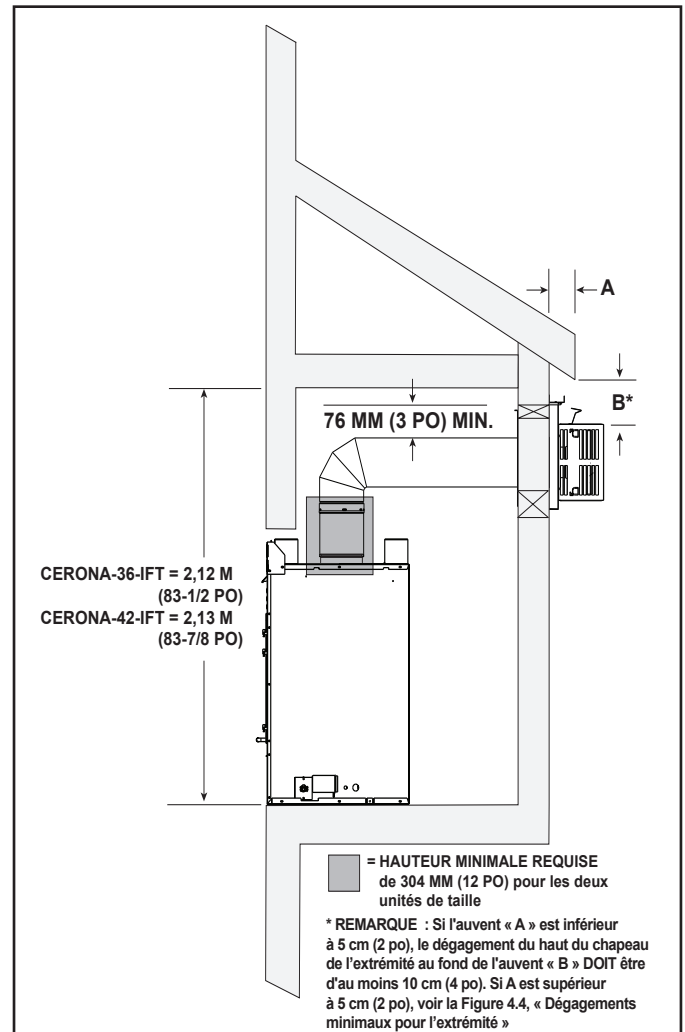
Enchâssure extérieure – Exigences minimales de hauteur
